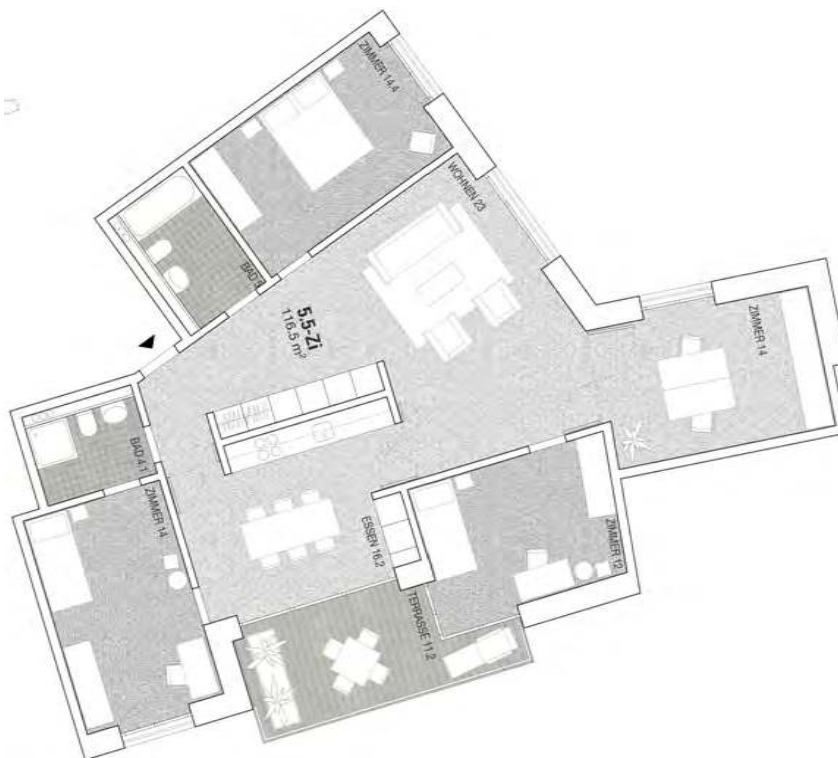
Leon: Wohnungsgrundriss 5.5-Zimmer-Whg.
